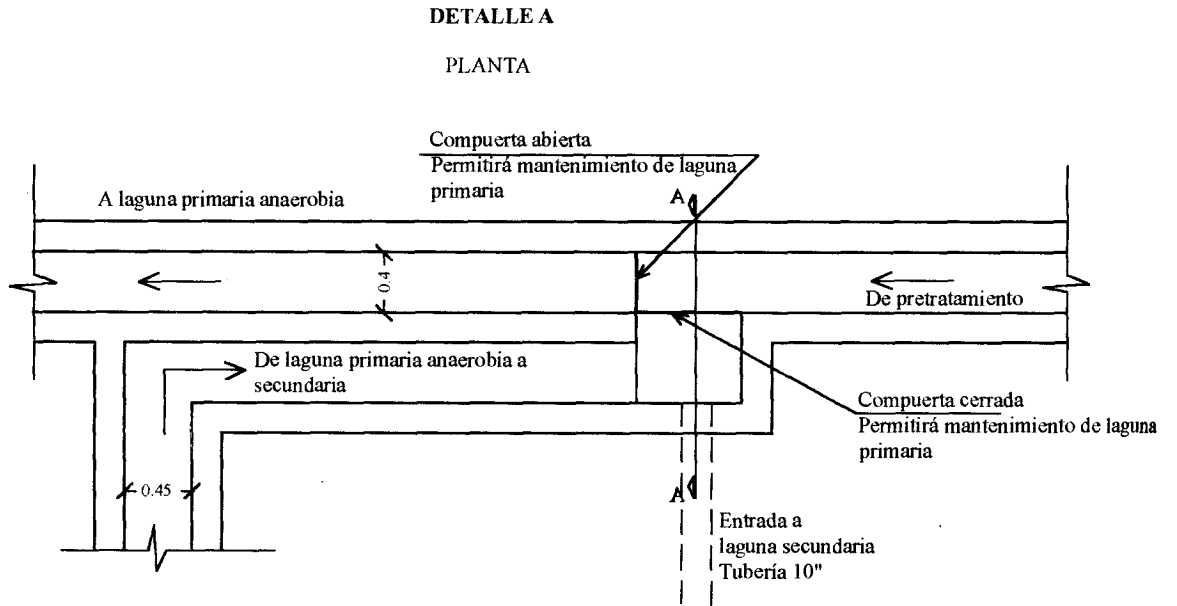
a. DETALLE A: Llegada de la interconexión a laguna secundaria (primaria existente)
